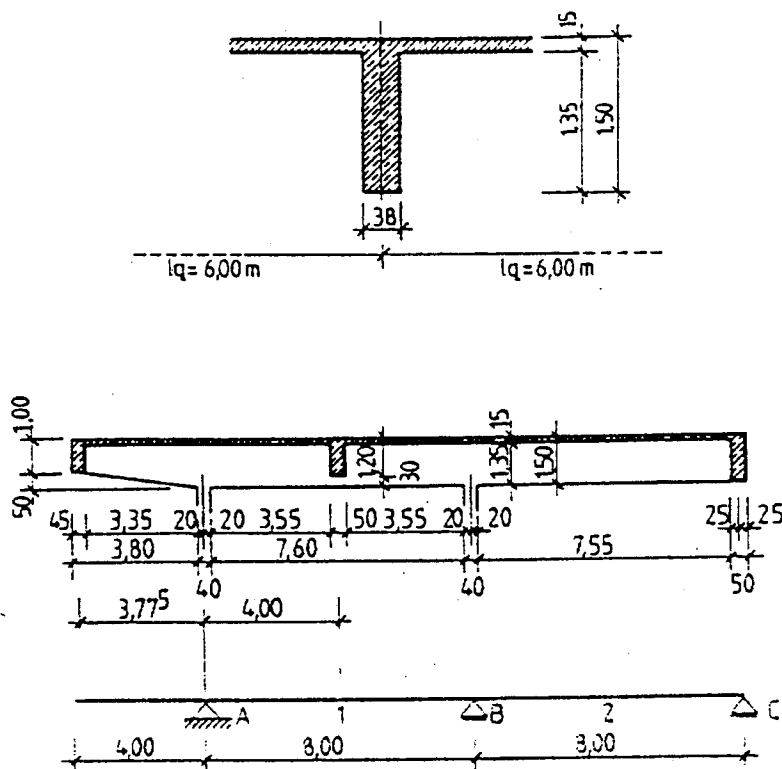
Quer- und Längsschnitt des Durchlaufbalkens
